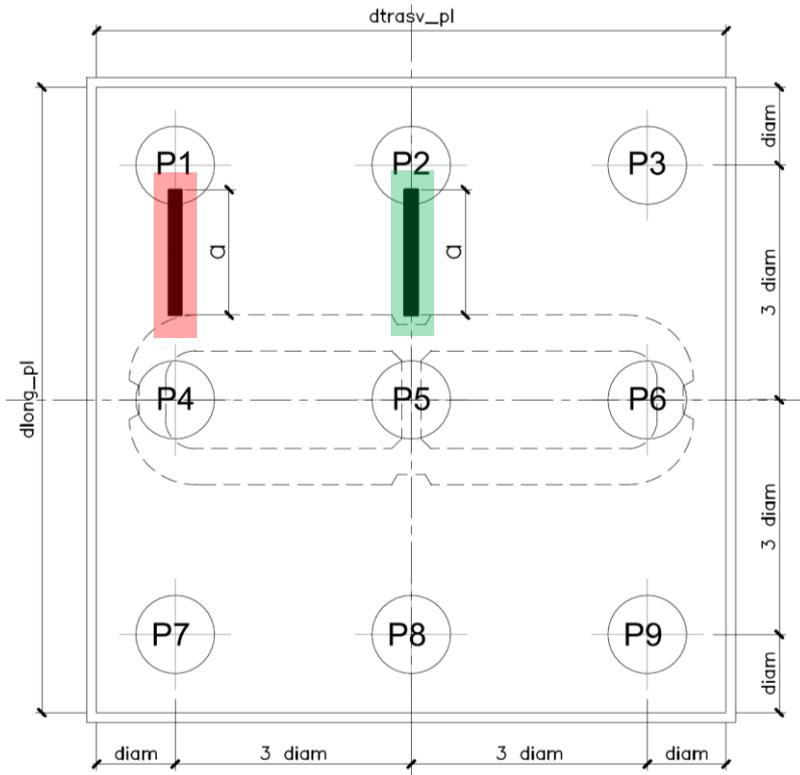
Vista in pianta - Tirante-puntone centrale (verde) e di spigolo (rosso)
